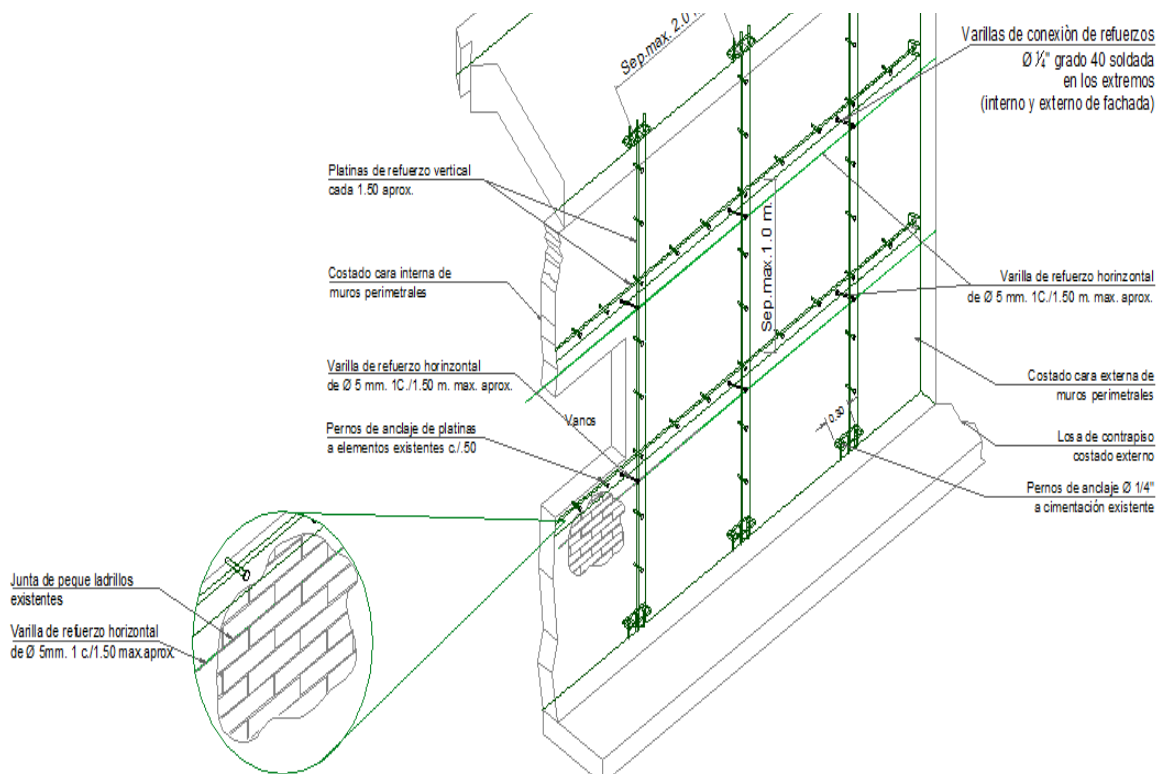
, Detalle constructivo del sistema de reforzamiento propuesto - perspectiva isométrica vista desde el interior. Fuente : Elaboración propia
